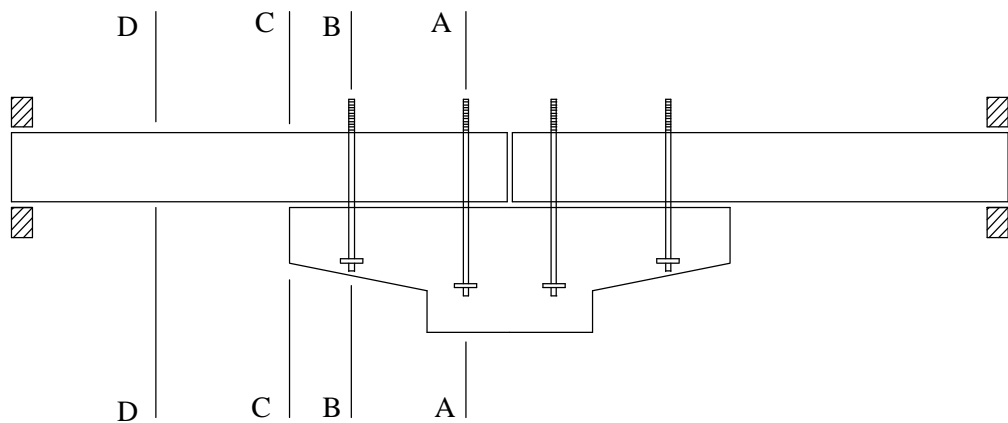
Seções instrumentadas da armadura longitudinal das vigas.
